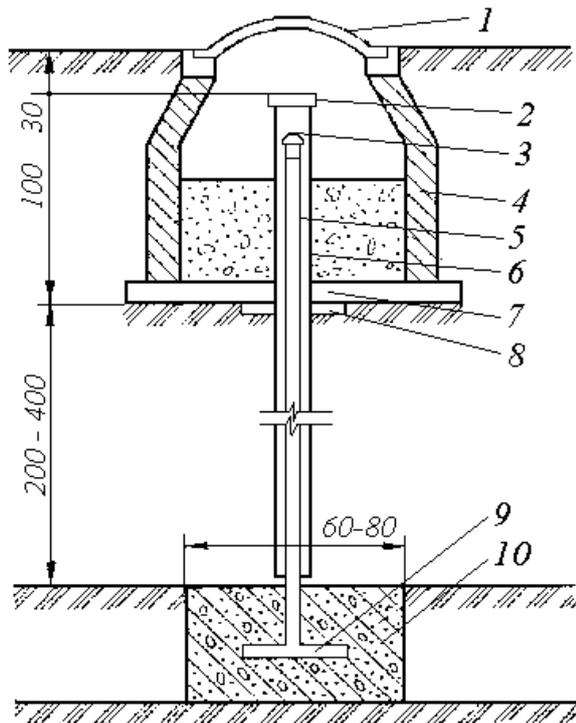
Трубчатый грунтовой репер на бетонном фундаменте:
